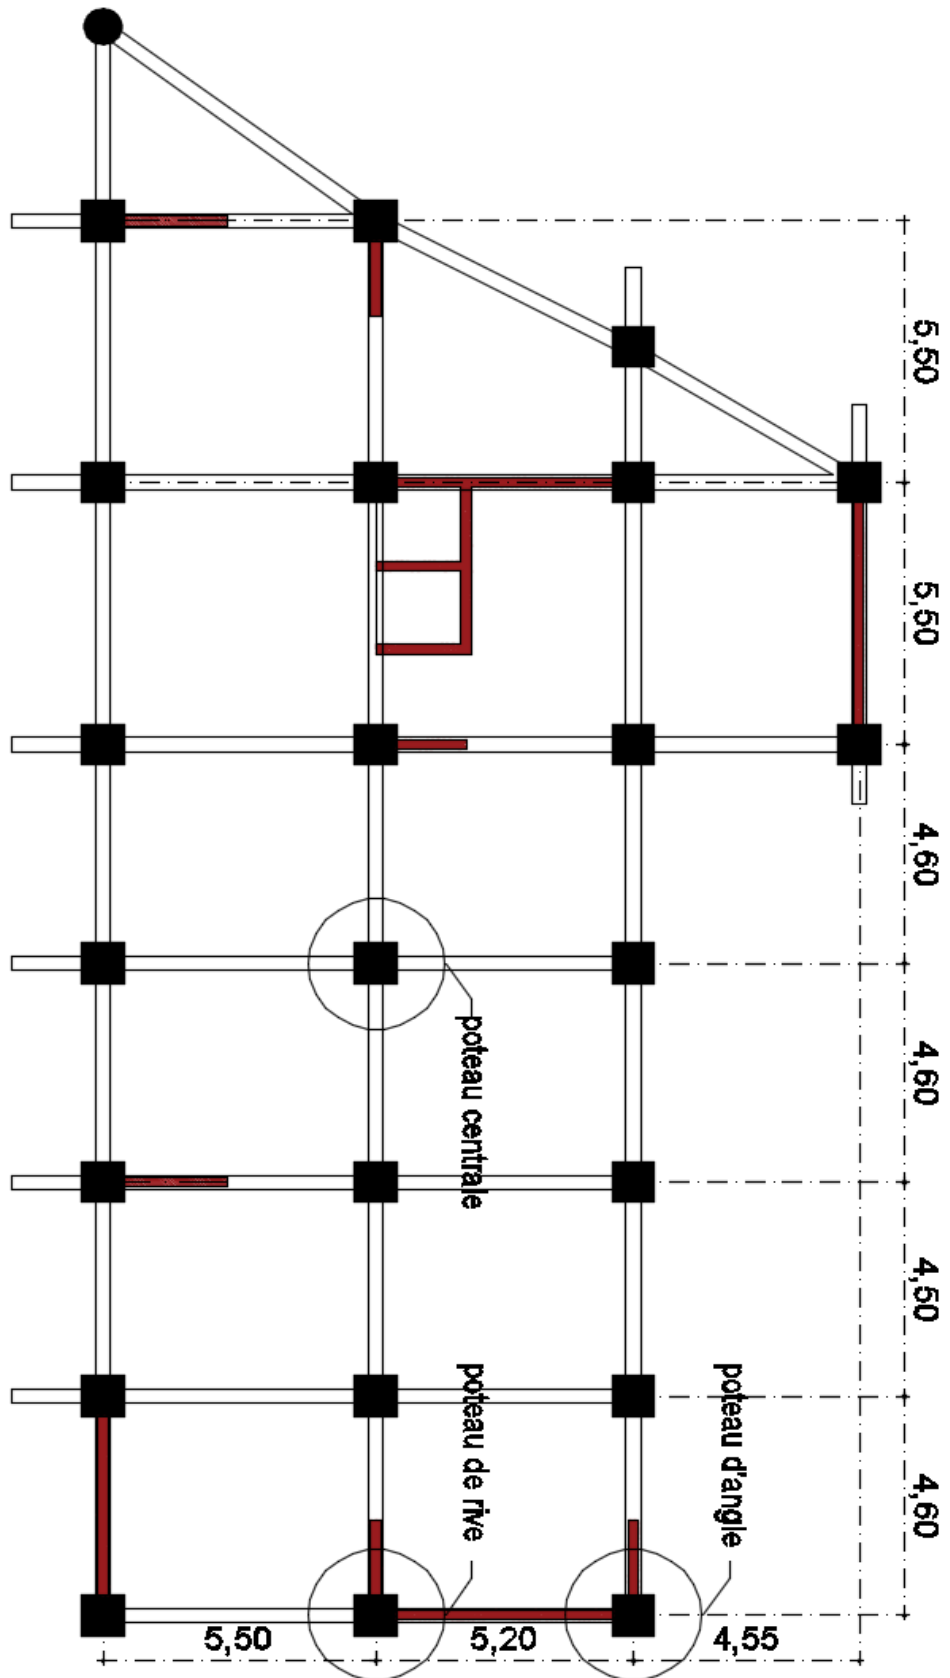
Plan de repérage des poteaux du prédimensionnement.
